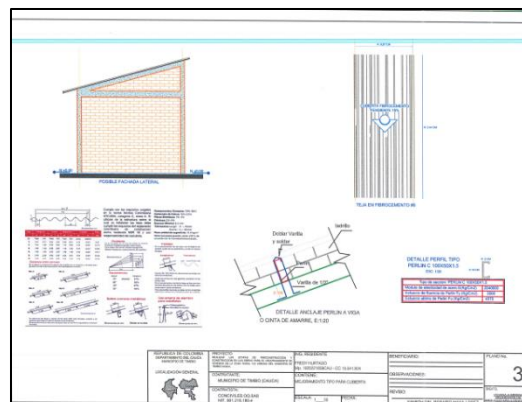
Plano Mantenimiento tipo para Cubierta (Fuente CONCVILES OQ SAS)
